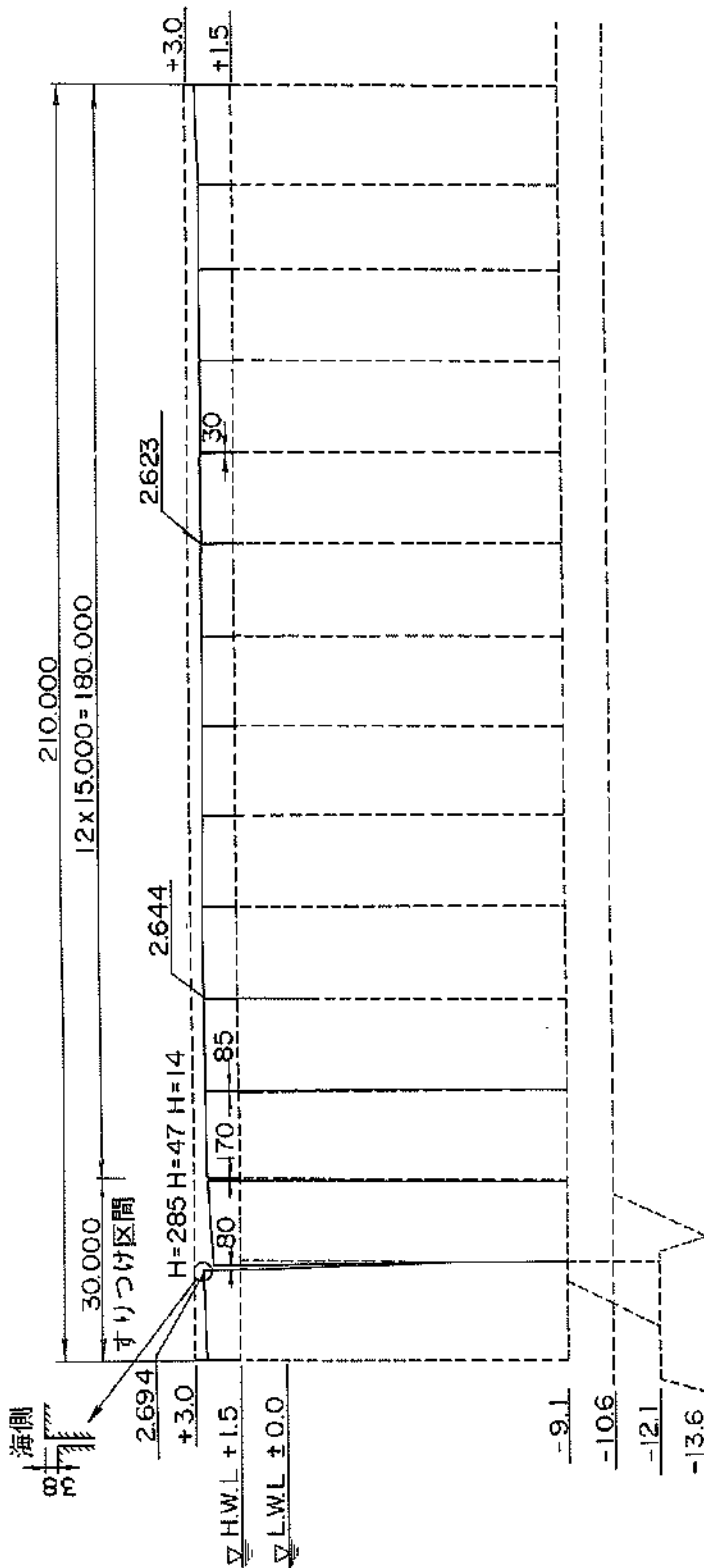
被災状況平面図・法線変位図(第2埠頭地区, ⑥西側岸壁(-9.0m))
